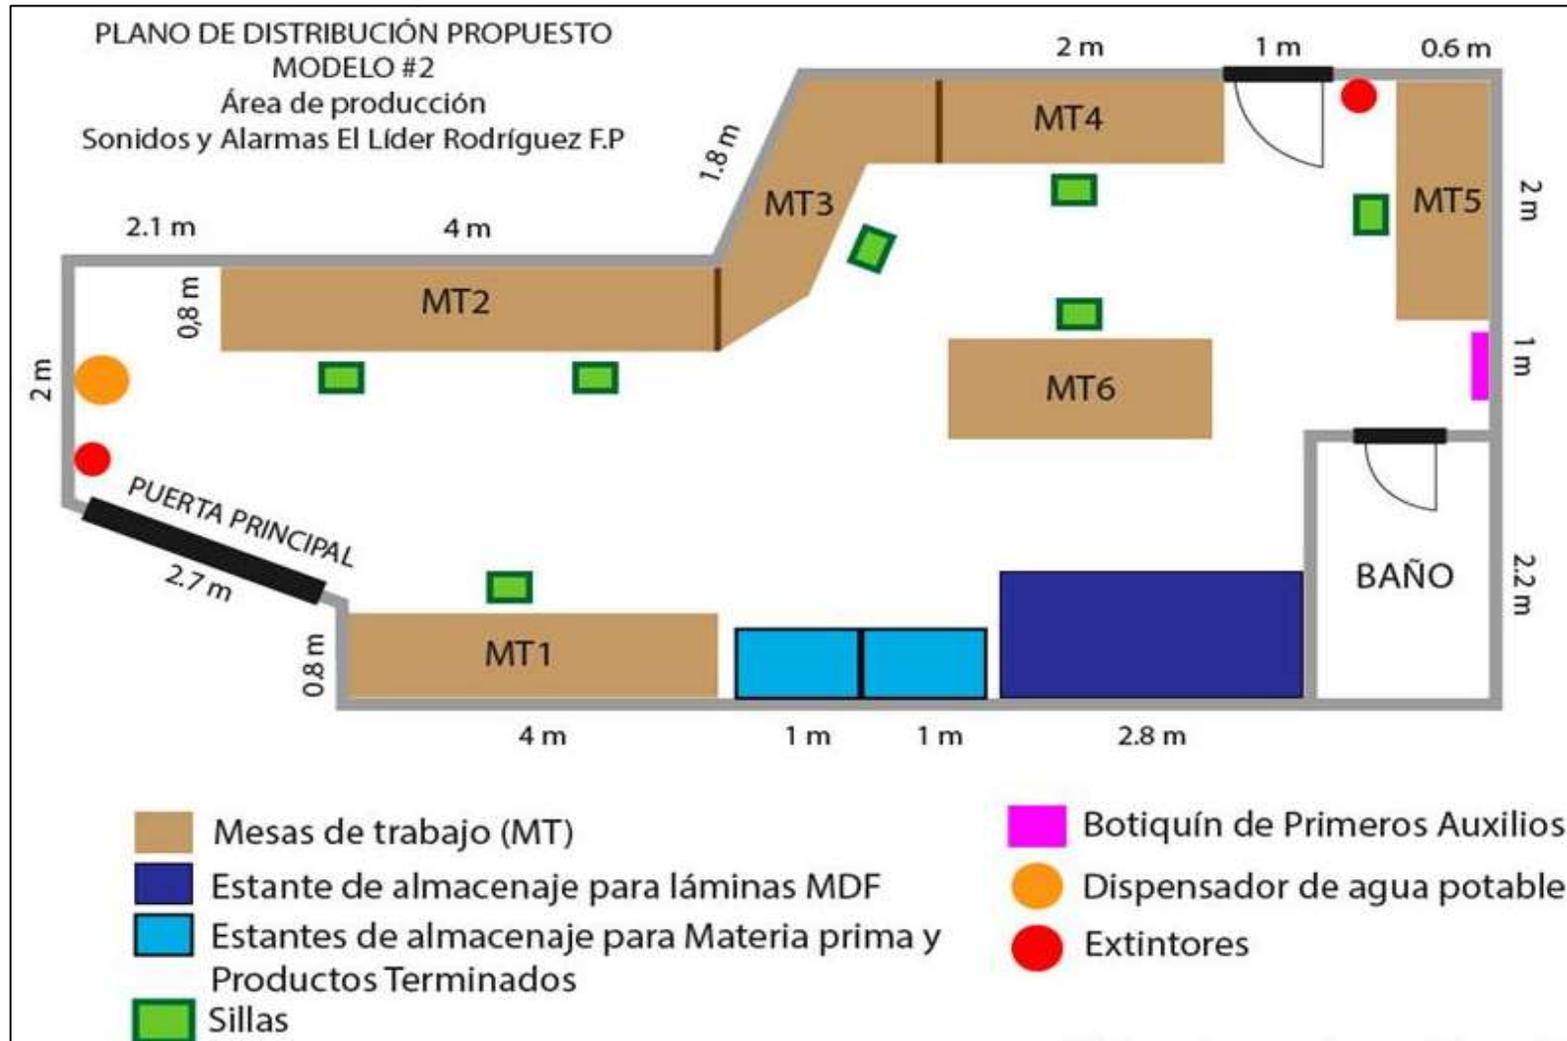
Alternativa modelo #2 de la distribución en planta propuesto. (Elaboración propia, 2024)
